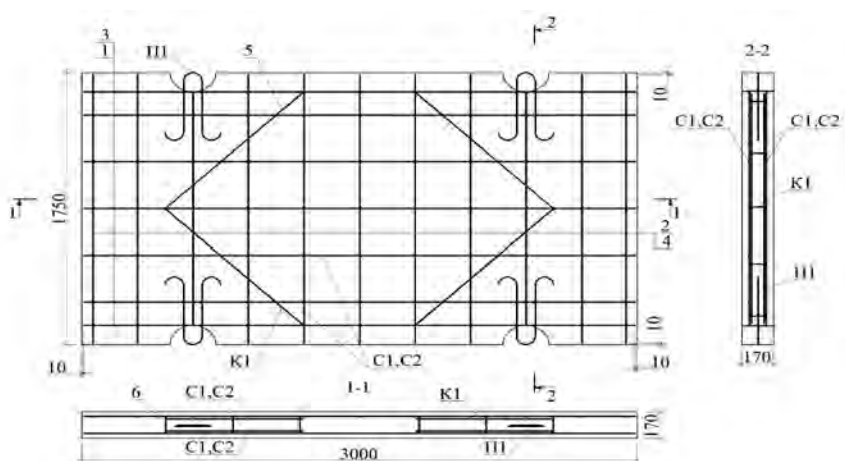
Опалубочные размеры и схемы армирования плит железобетонных для покрытий автомобильных дорог марок 1ПП30.18-30, 2ПП30.18-30.
